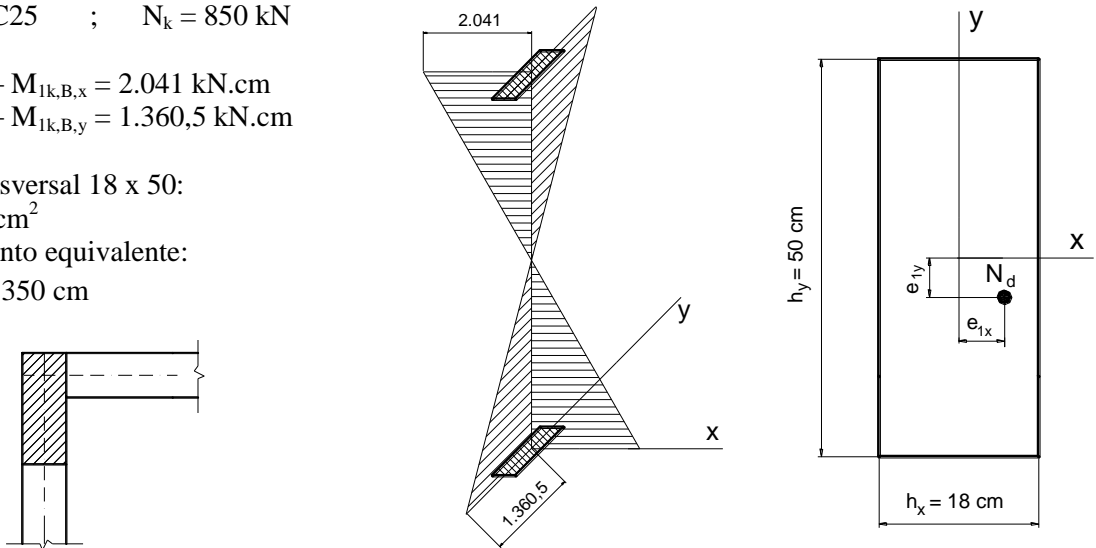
Arranjo estrutural do pilar na planta de fôrma, dimensões da seção transversal e posição do ponto de aplicação da força normal  $N_d$ , e momentos fletores solicitantes de 1ª ordem.
